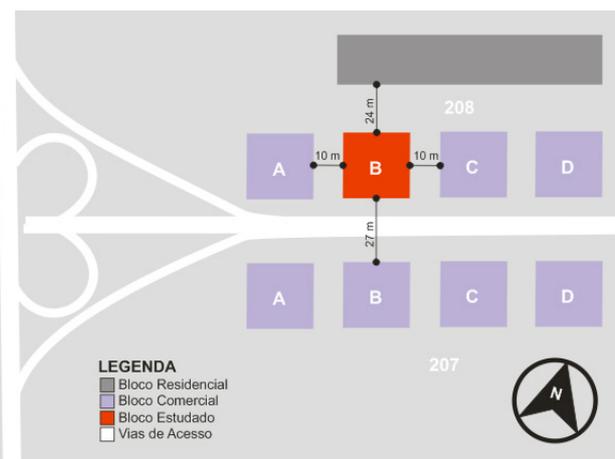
Planta de Situação da Amostra B (CLN 208 Bloco B)
